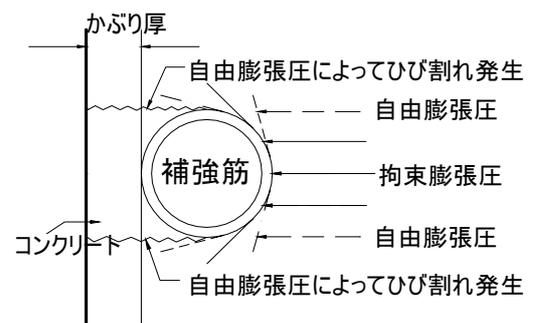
コンクリート内部膨張圧とひび割れ発生メカニズム
